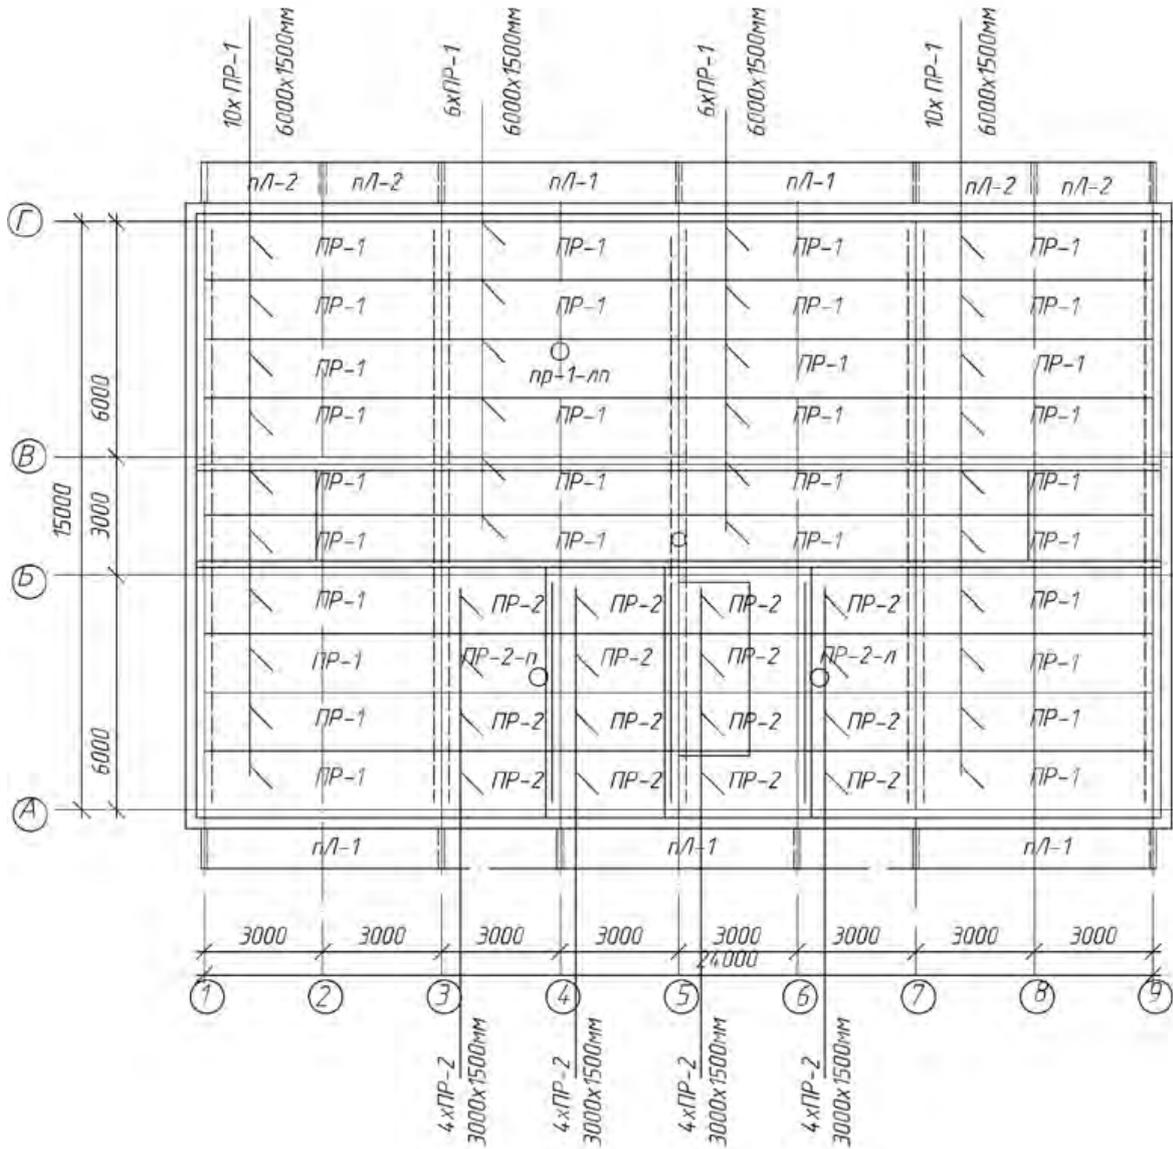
План покрытия в здании с поперечным каркасом: ПР — плита покрытия ребристая; ПЛ — плита лоджии
